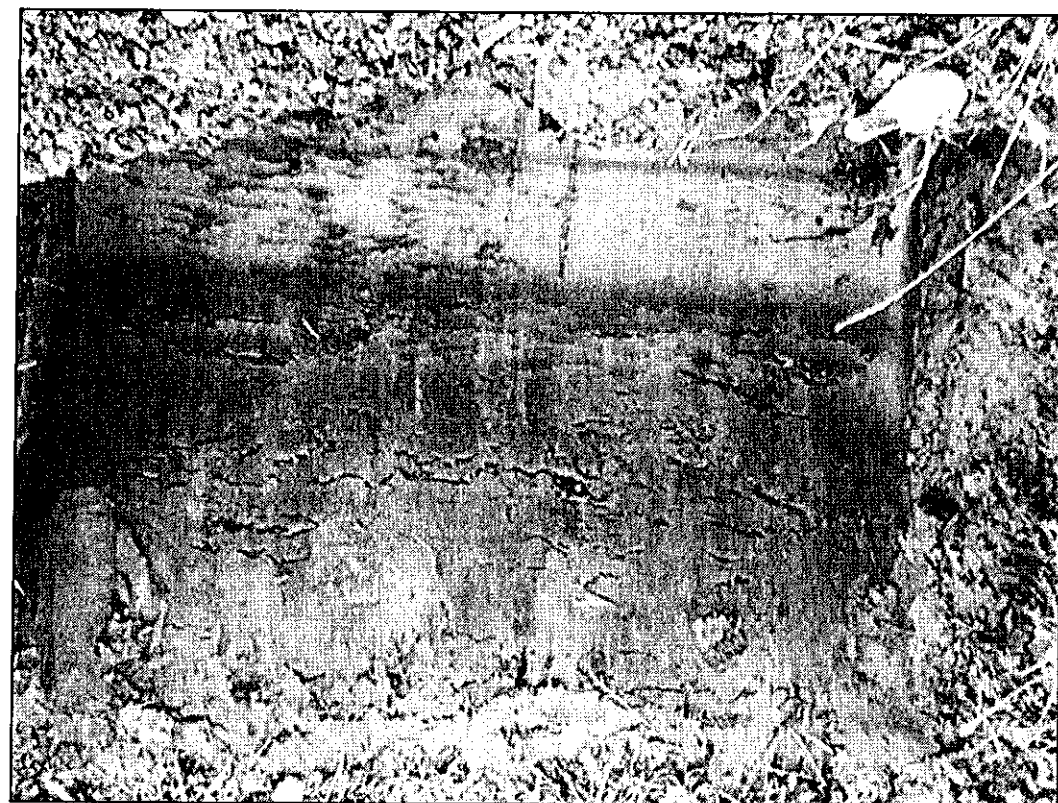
Pozzetto n° 22. Profondità -1,3 m dal p.c.
